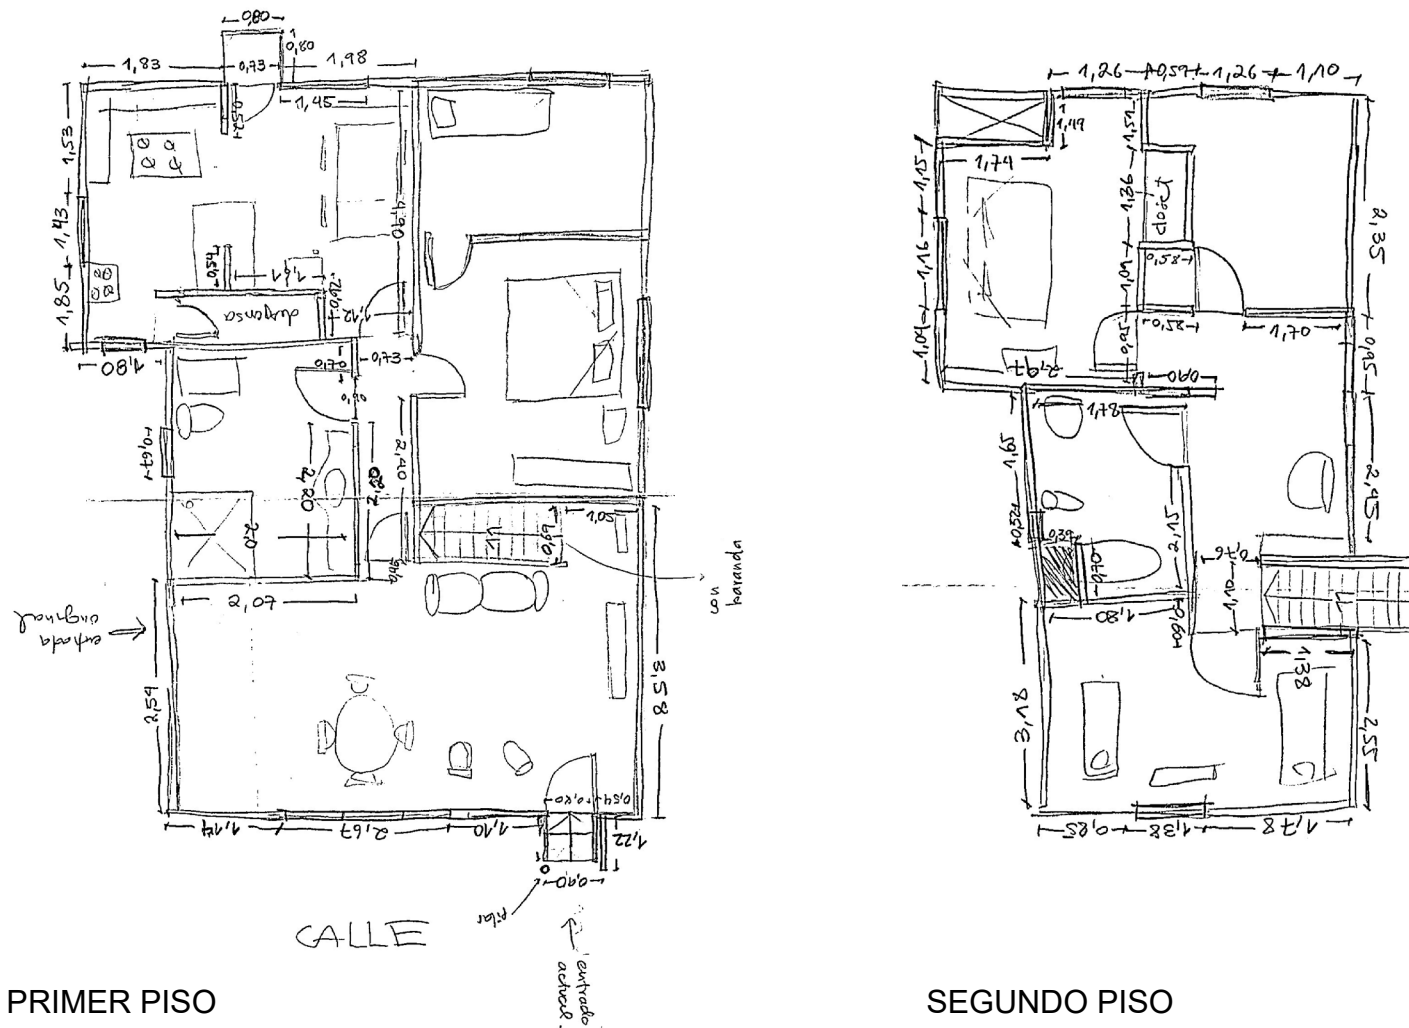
Levantamiento planimétrico hecho en terreno. Vivienda de Noemí y Toño. Fuente: Elaboración propia, 2019.
